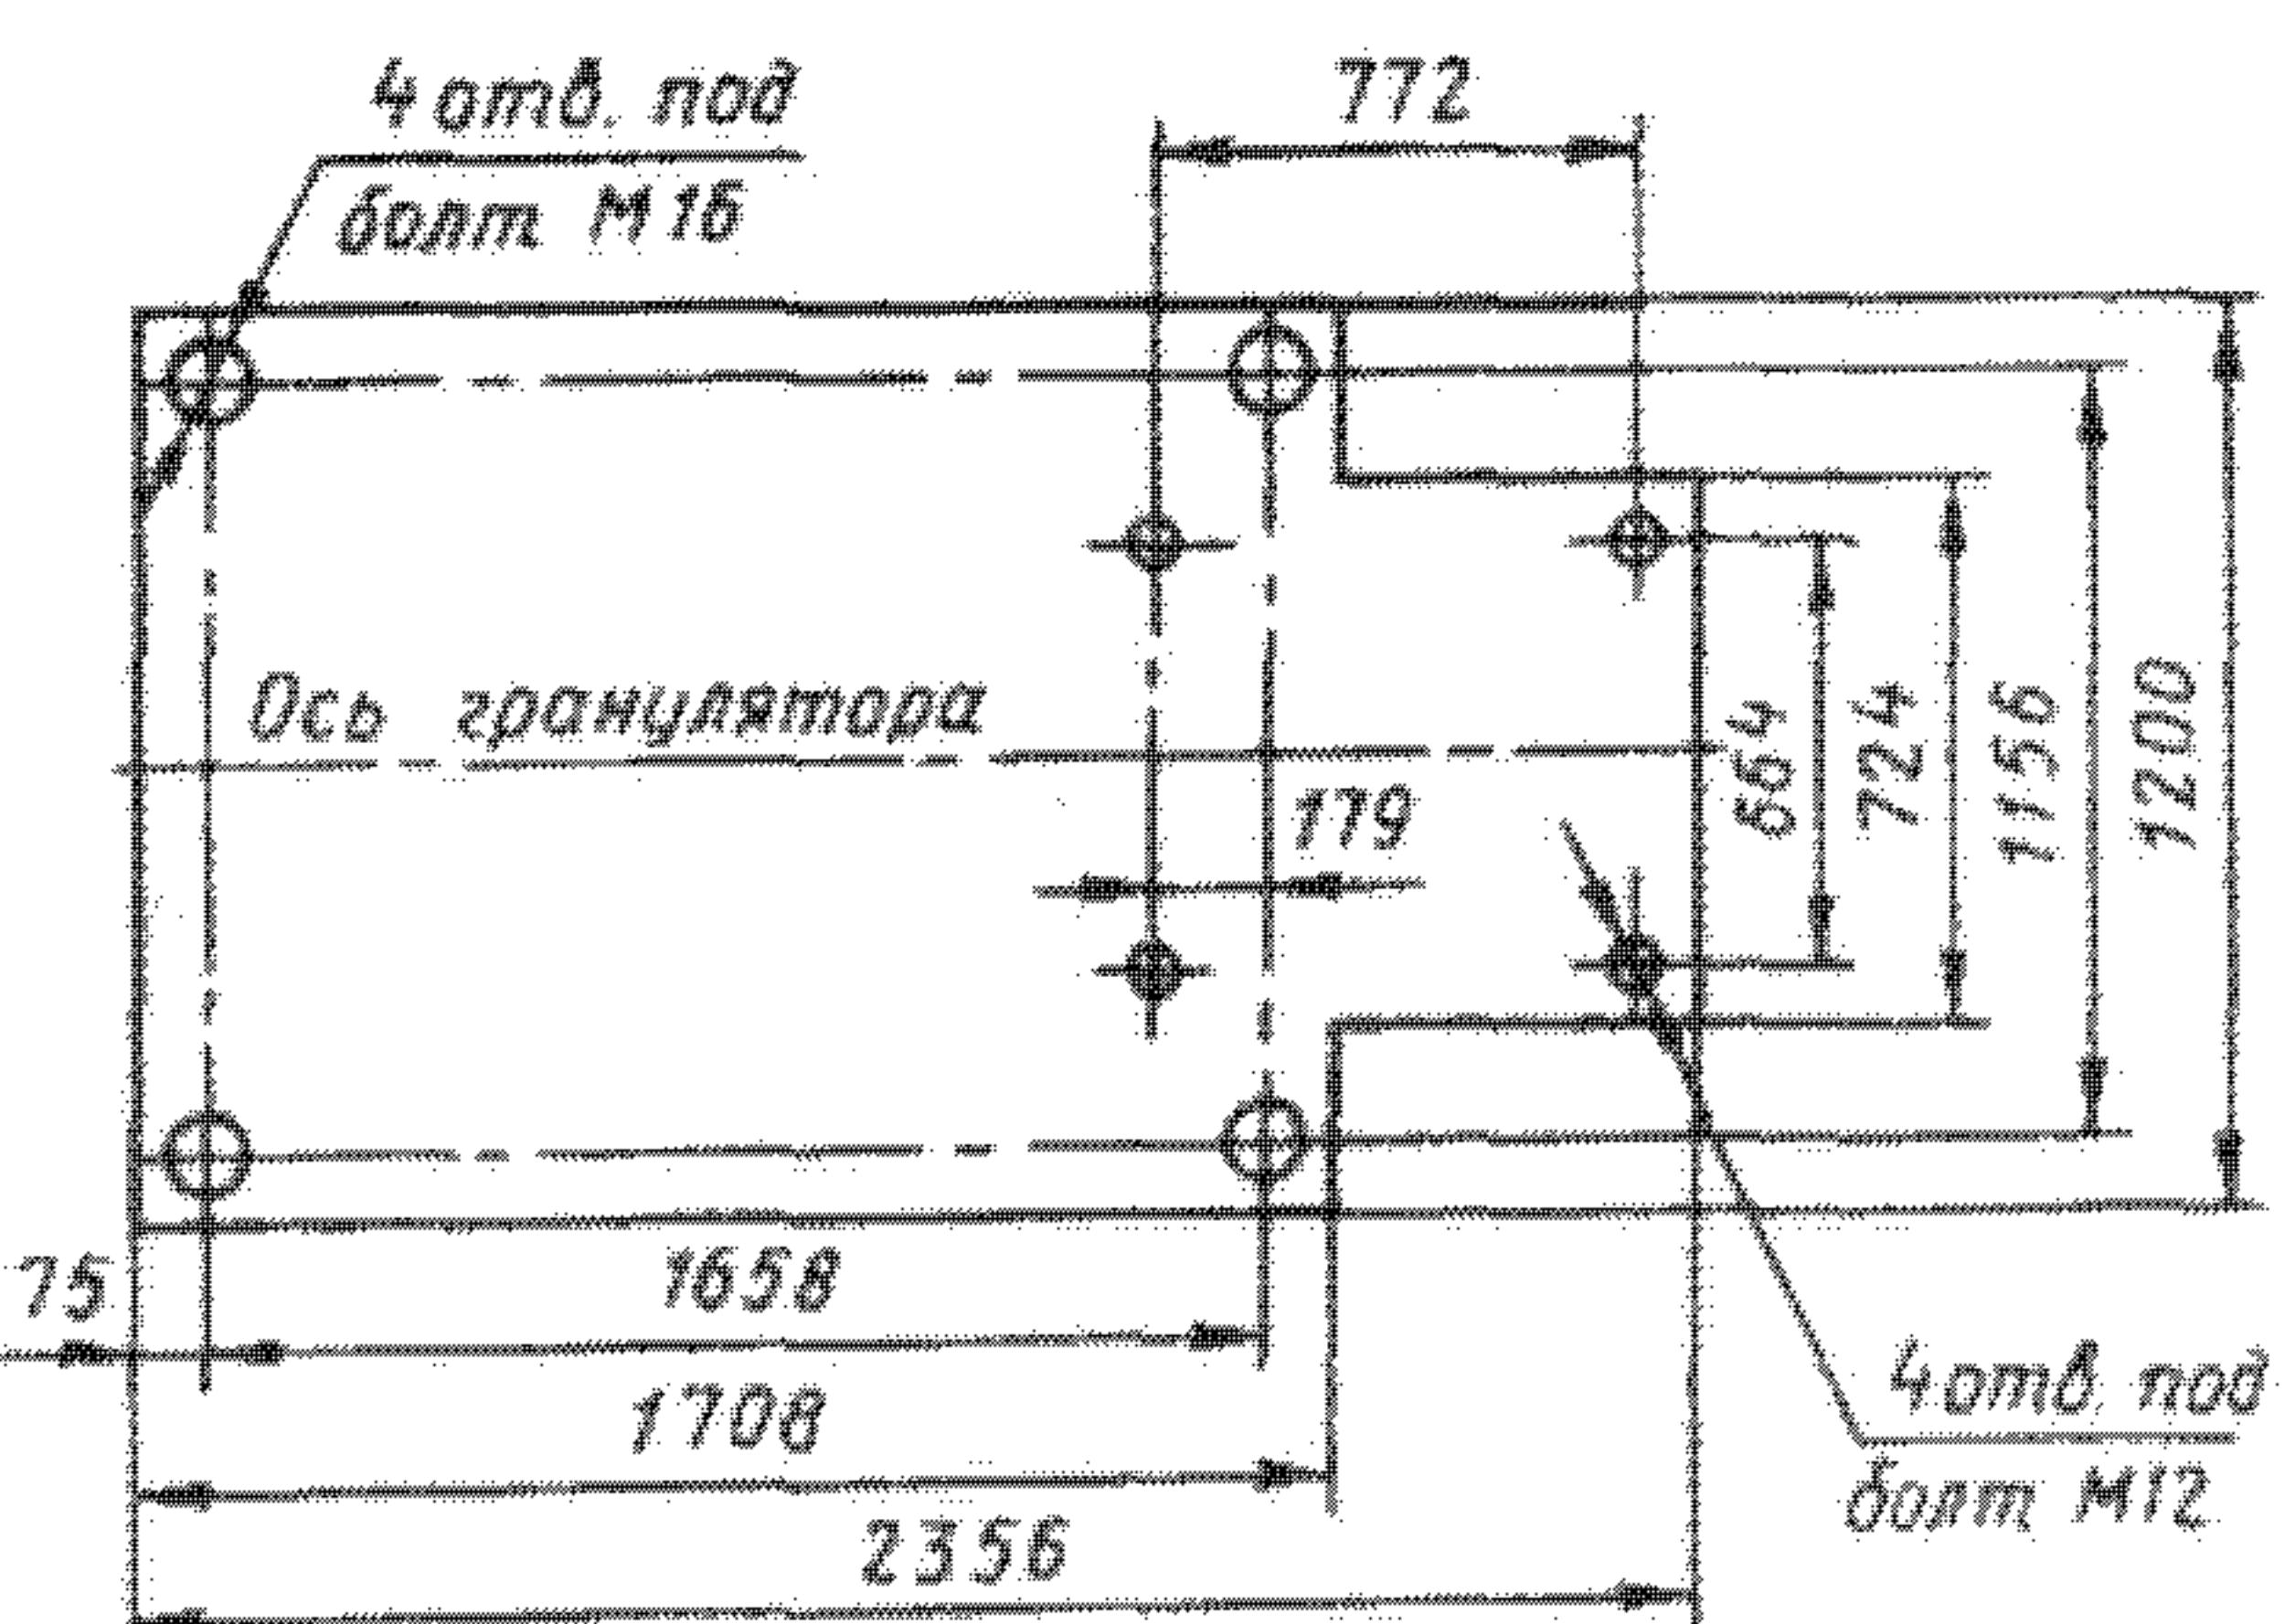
План расположения отверстий под фундаментные болты гранулятора
